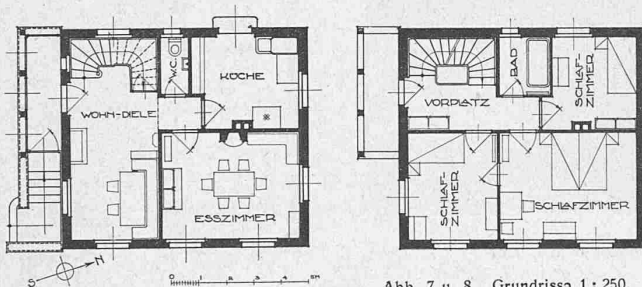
u. 8. Grundrisse 1:250.
